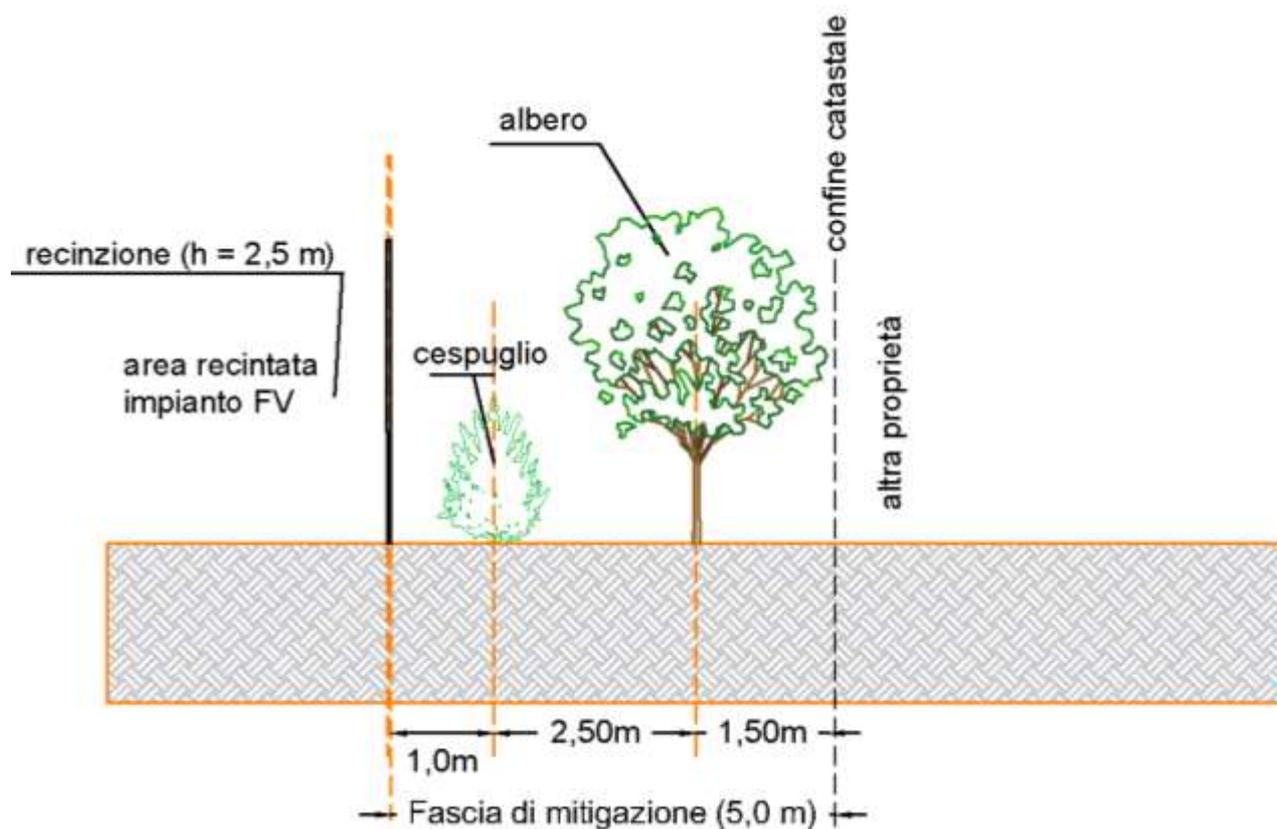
Stralcio di sezione dell'area perimetrale dell'impianto.
